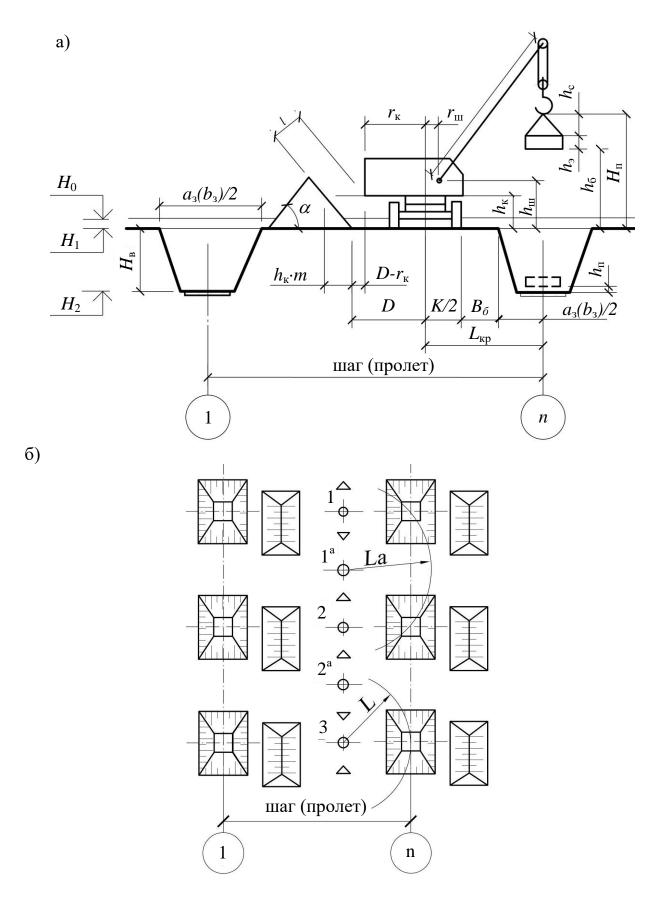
Схема установки крана при наличии кавальеров: а) разрез; б) план (рис. 22б), 1, 1а, 2,... – рабочие стоянки; L – минимальный вылет для монтажа одного фундамента со стоянки; $L_{\rm a}$ – минимальный вылет для монтажа двух фундаментов с одной стоянки в стесненных условиях
